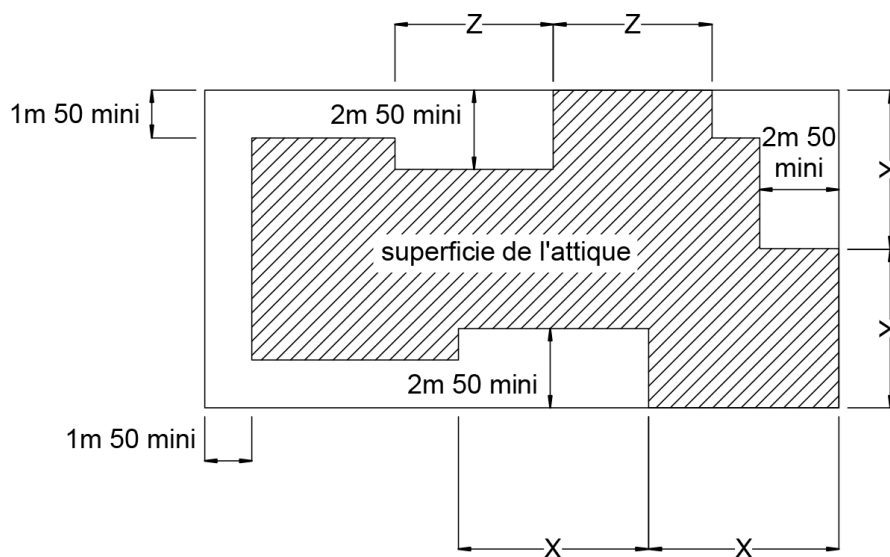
désormais, l'attique doit présenter un retrait minimal d'au moins 1 m 50 sur une façade entière.
